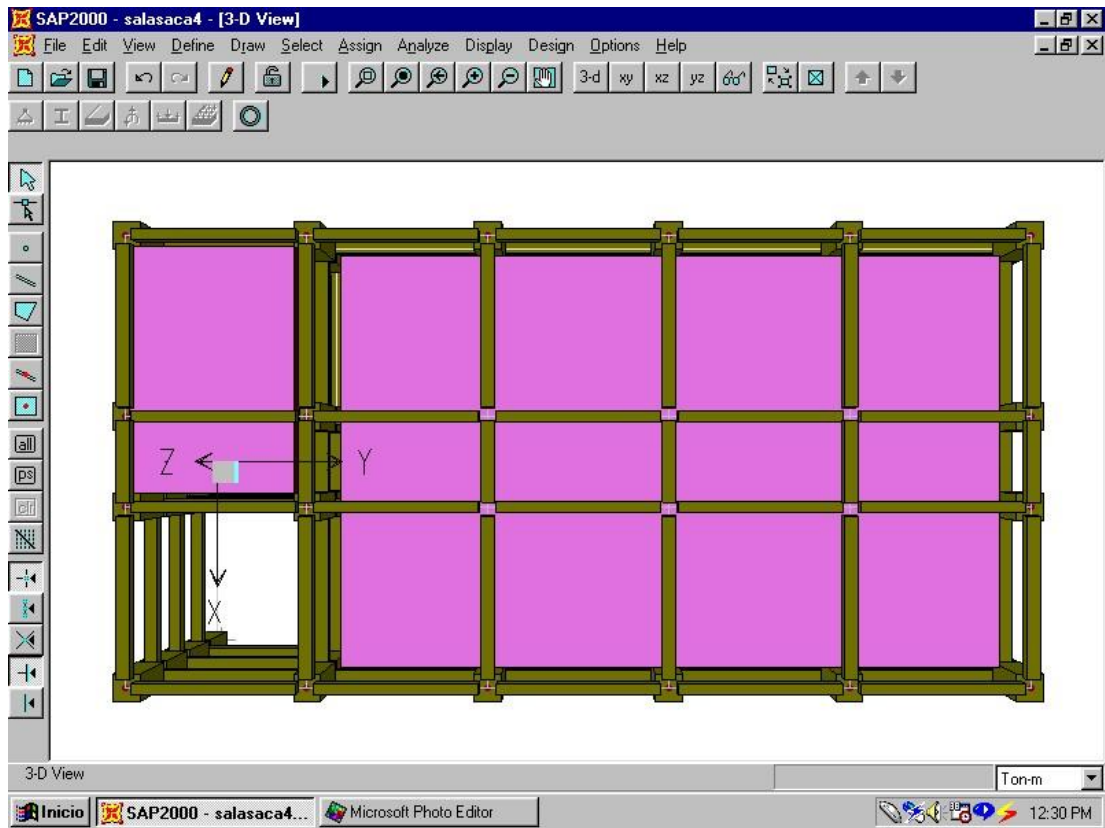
Pórtico espacial. Secciones de vigas, columnas y losas en el plano X-Y.
